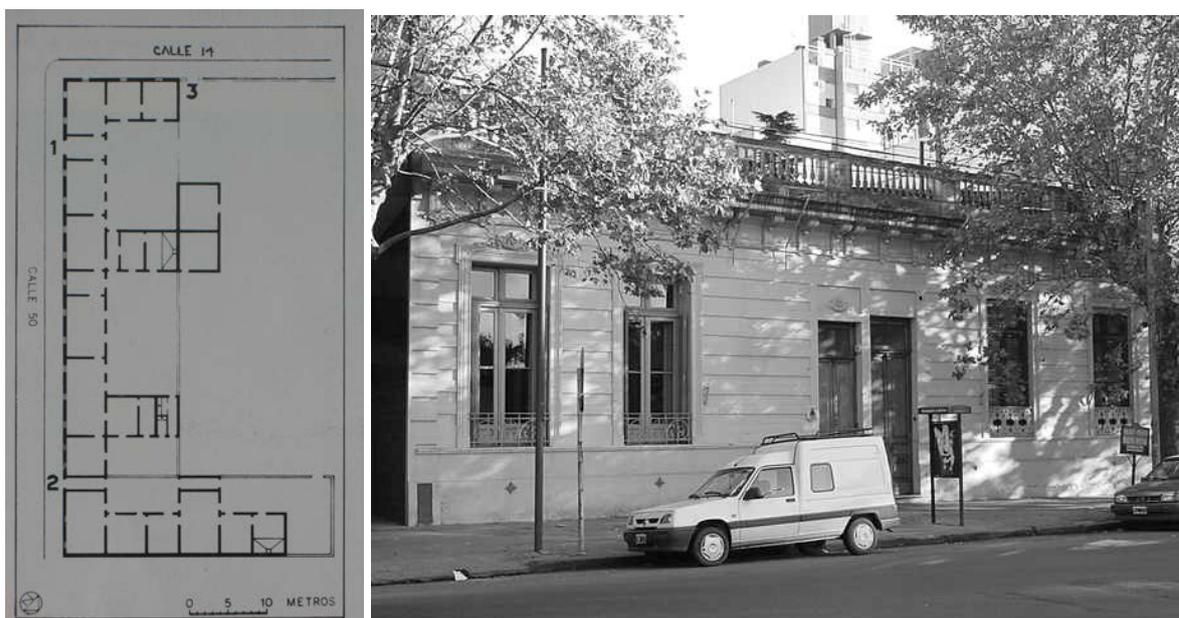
Casa Rocha. Calles 14 y 50. La Plata. Planta de situación original.
